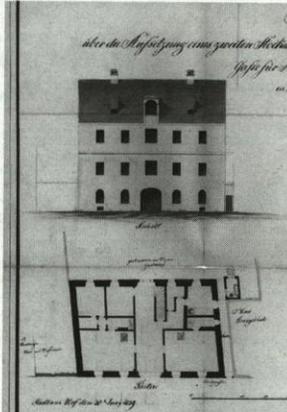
Obere Bachgasse 23, Aufstockung 1839, Ansicht und Grundriss des Erdgeschosses (BOAR).
